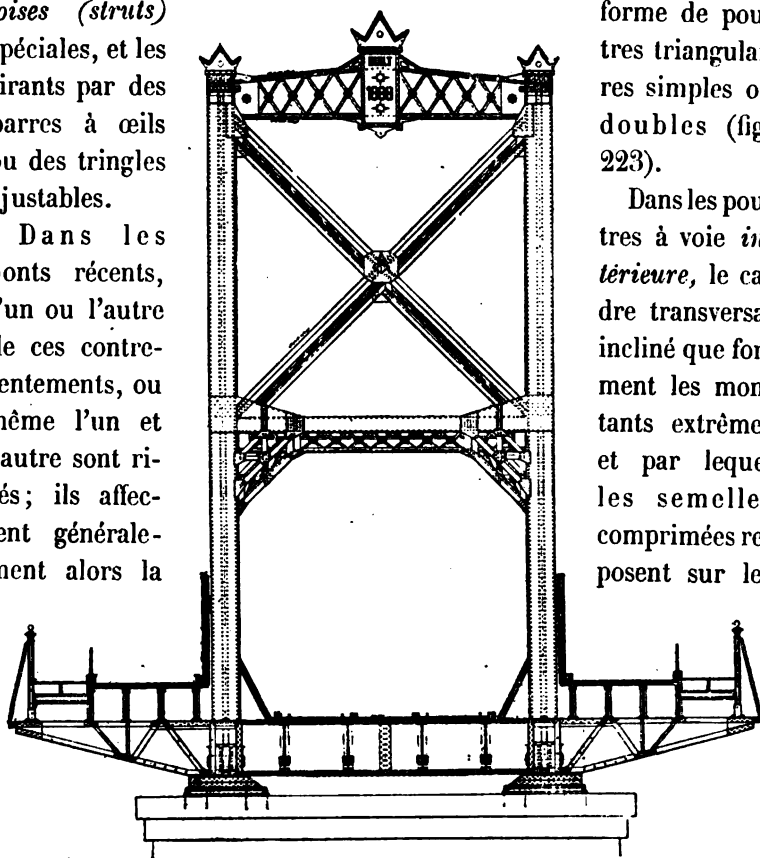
Pont de Cincinnati et Covington. — Portail extrême de la travée de 167^m,75.
